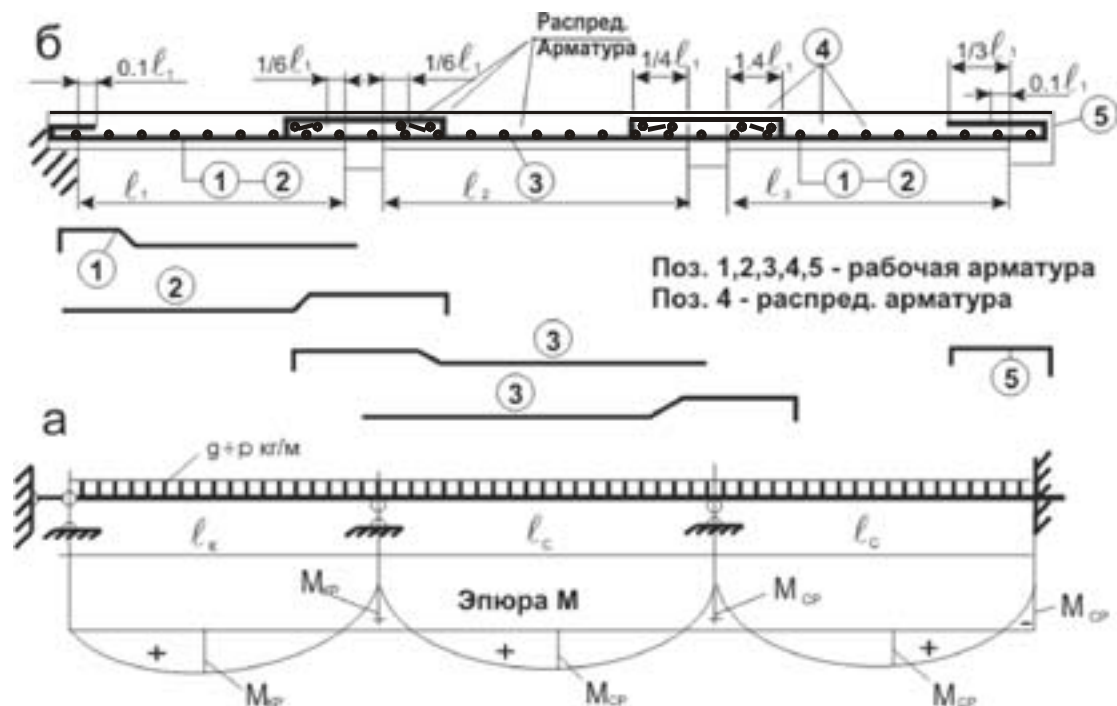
Расчетная схема плиты монолитного ребристого перекрытия
